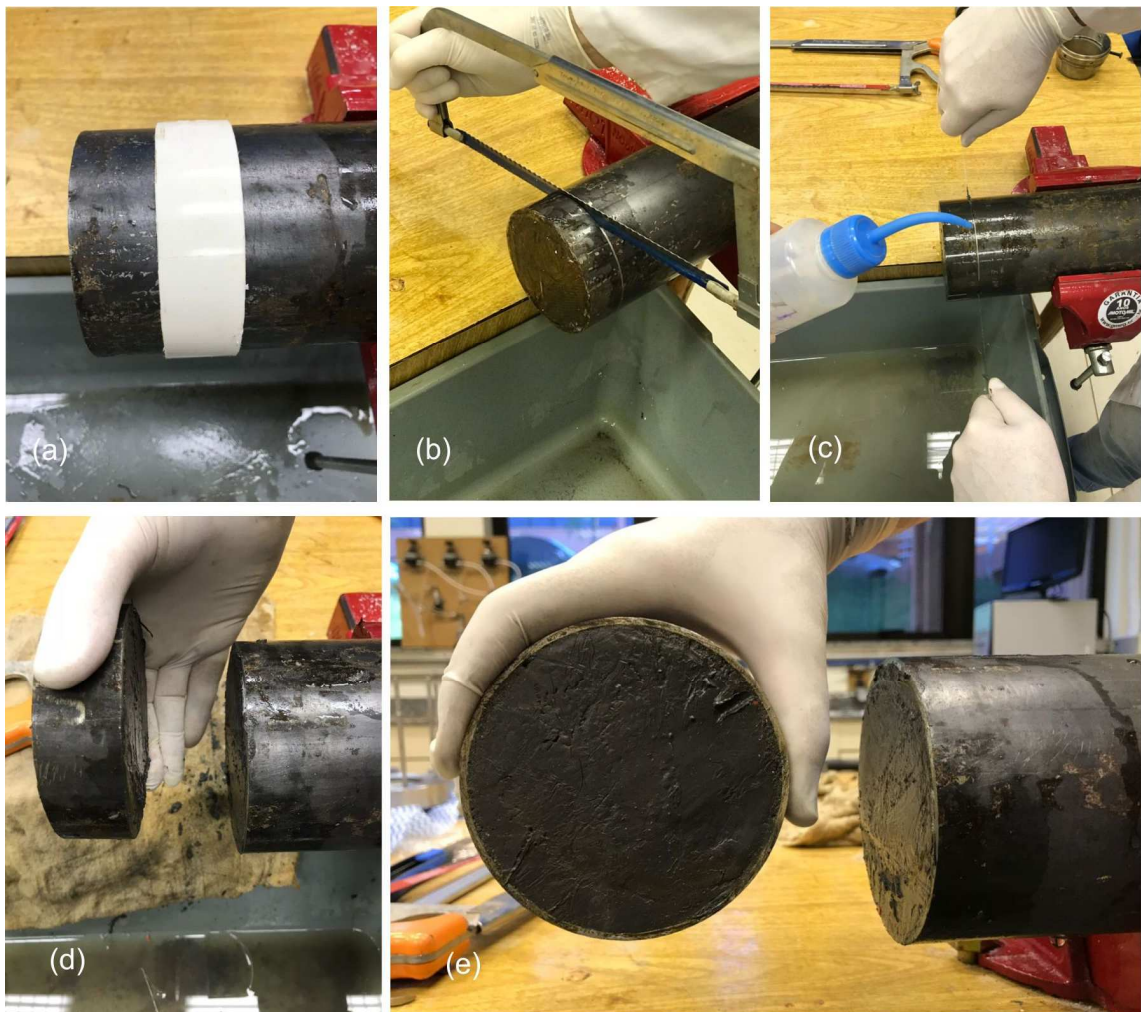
Manuseio corte do tubo shelby para montagem do corpo de prova indeformada.
